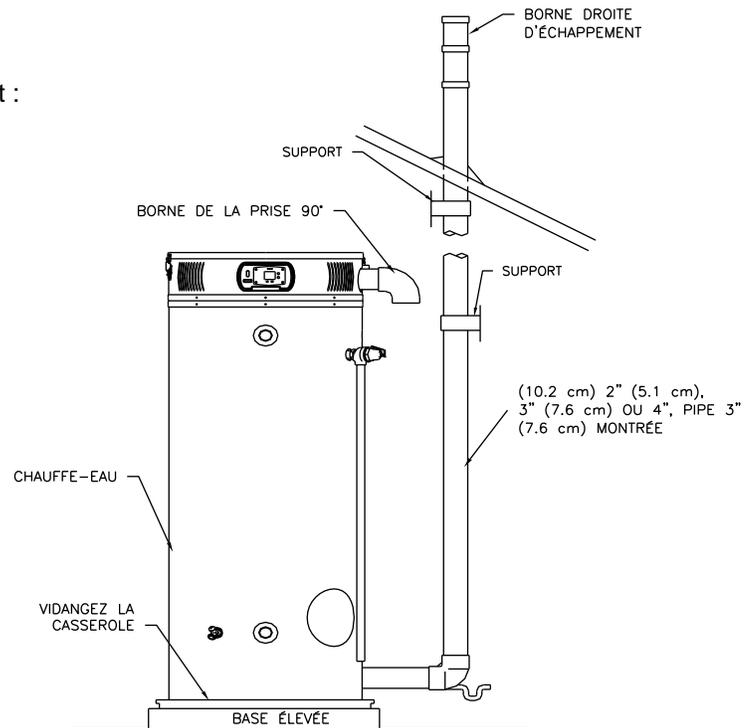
Installation d'un système de ventilation forcée vertical typique
